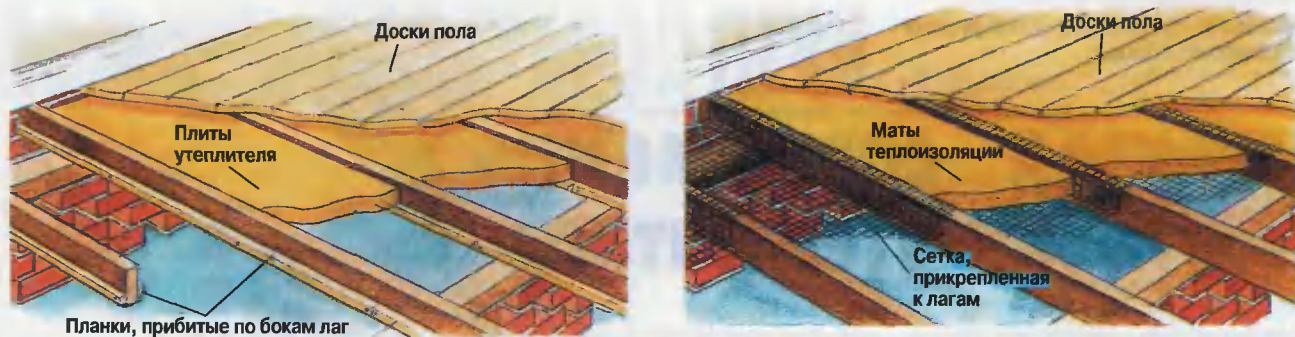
Для теплоизоляции деревянных полов укладывают пенополистирол на планки, прибитые к боковым сторонам лаг, или на садовую сетку, прикрепленную к лагам, чтобы зафиксировать маты теплоизоляции между лагами
